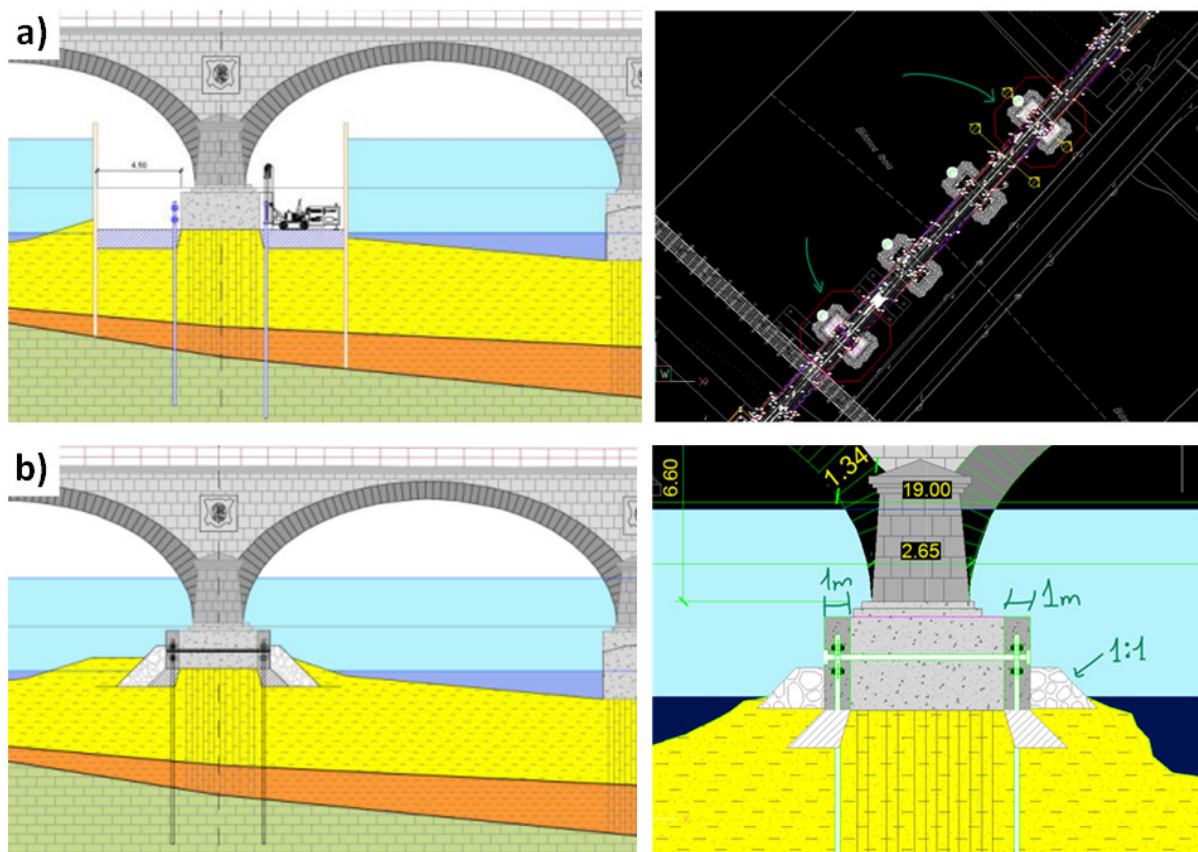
Geometría de la situación temporal con recinto de tablestacas en pilas 1 y 4 (a) y de la situación futura con encepados reforzados en pilas 1 y 4 y escollera en todas las pilas (b).
